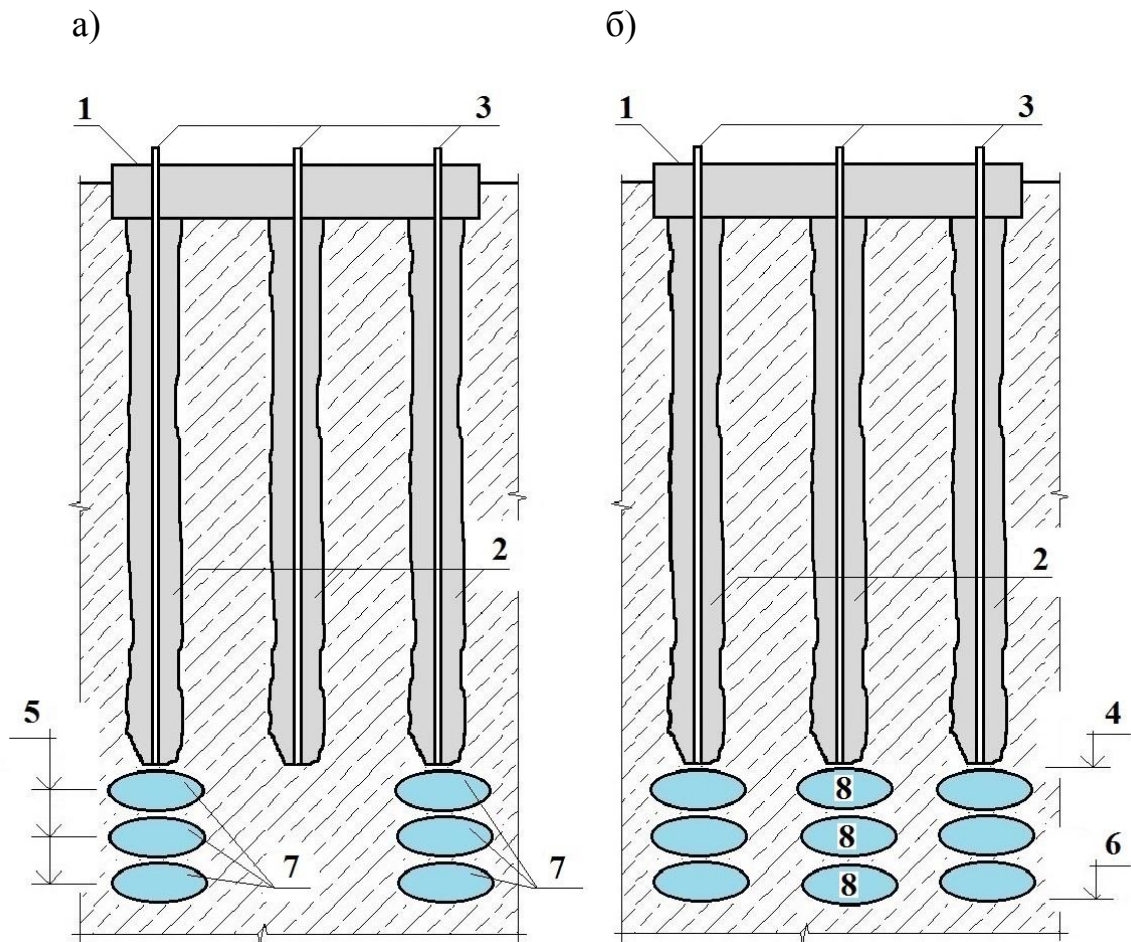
Этапы усиления свайных фундаментов пакетным высоконапорным инъецированием: усиление грунтового основания под крайними (а) и под внутренними сваями (б). 1 – свайный ростверк; 2 – буронабивные сваи; 3 – инъекторы; 4 – высотная отметка нижнего конца свай; 5 – высотные отметки инъекционных горизонтов; 6 – граница сжимаемой толщи; 7, 8 – горизонтальные инъекционные тела под крайними и внутренними сваями.
